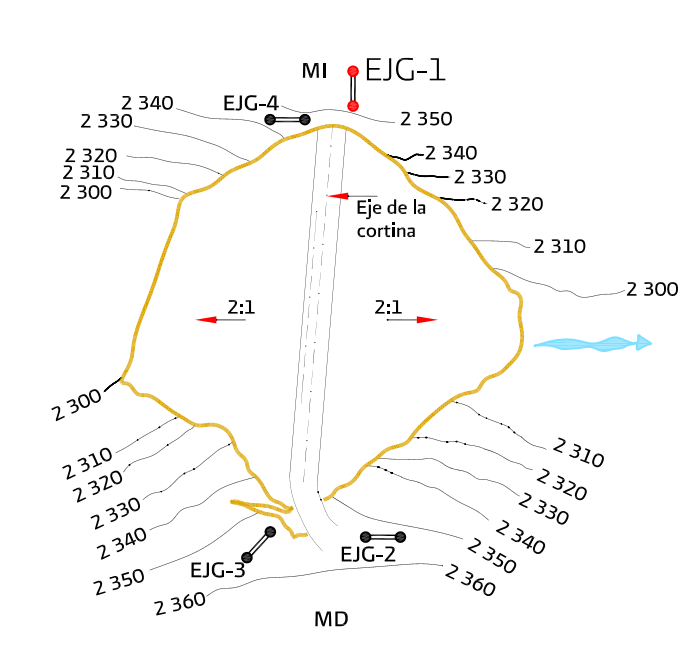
Tipos de extensómetros externos de juntas y grietas
